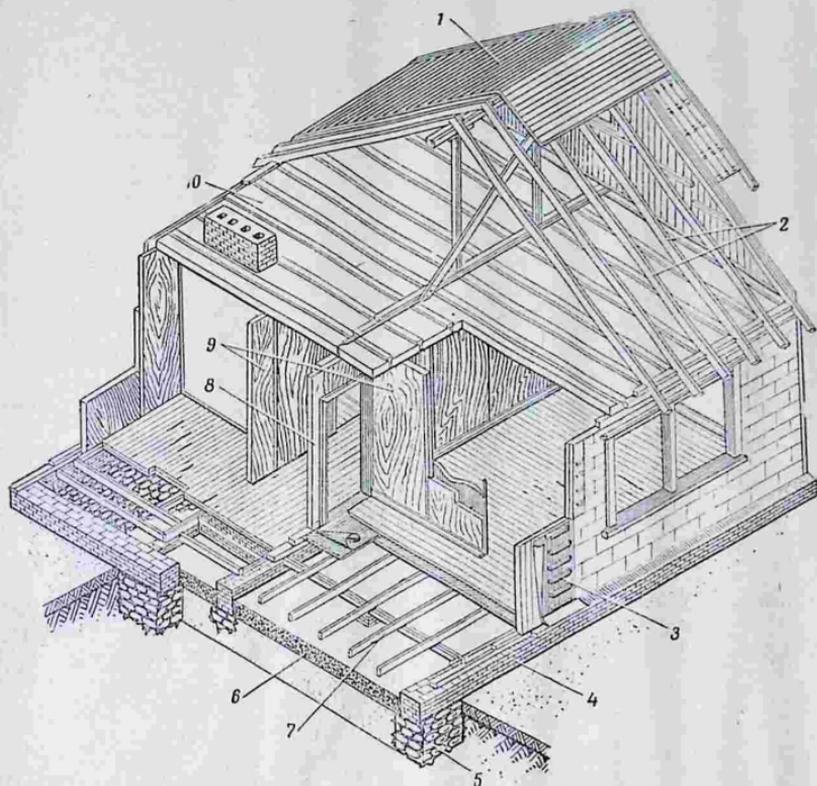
Сборная конструкция одноквартирного, трехкомнатного жилого дома: 1—щиты обрешетки для кровельных асбестоцементных листов; 2—стропильная нога; 3—щит наружной стены (сухая штукатурка, шит, толь, рейки, асбестоцементные плиты); 4—кирпичный цоколь; 5—бутовый столбчатый фундамент; 6—подготовка под полы; 7—полы (балки, носовый настил, толь, половые доски); 8—внутренняя несущая стена; 9—щитовая перегородка; 10—чердачное щитовое перекрытие.
